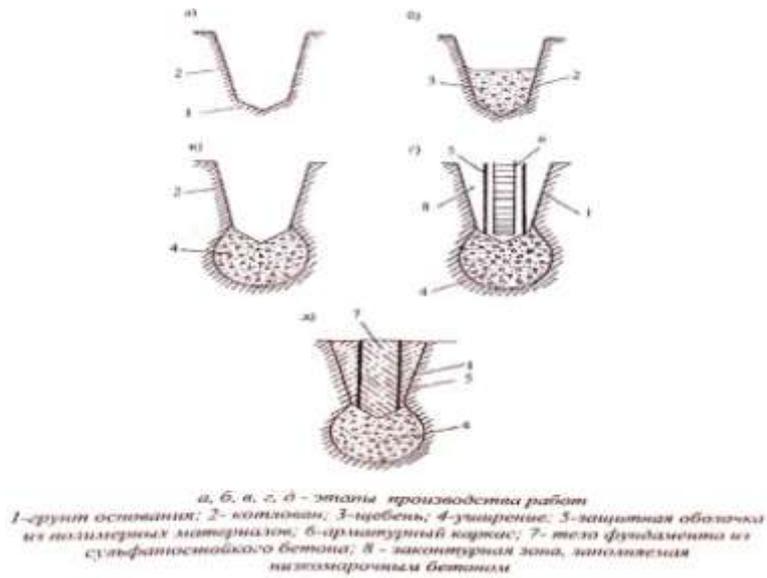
Фундаменты в вытрамбованных котлованах на засоленных грунтах с защитной оболочкой из киров.
